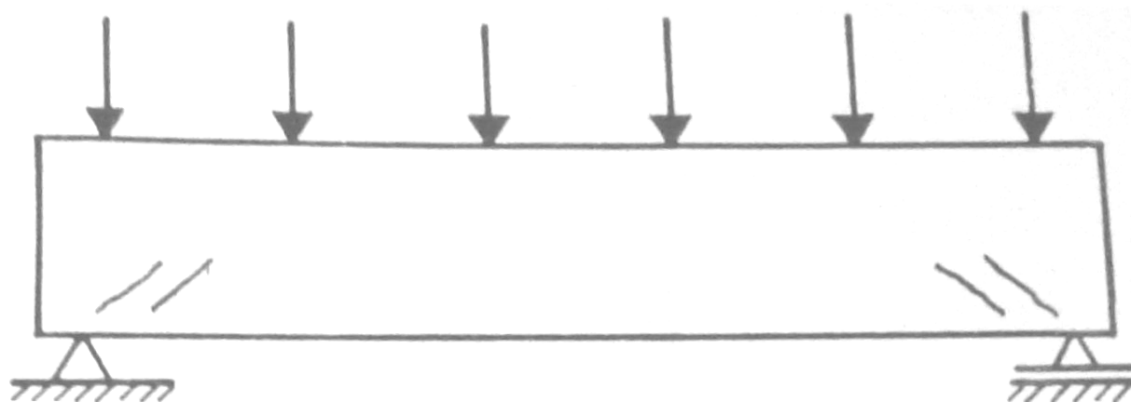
Fissura de cisalhamento em viga solcitada à flexão. (Fonte: THOMAZ)
